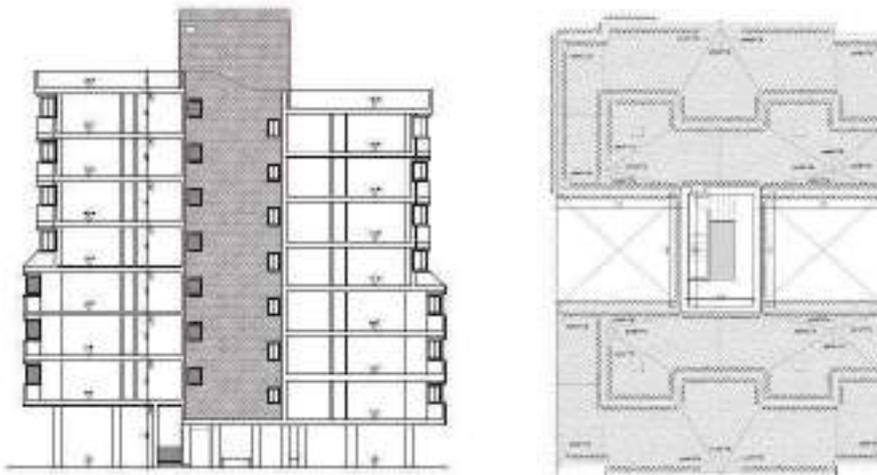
Sección del bloque “Tipo A” y planta de cubiertas. (Fuente: Proyecto ORS)
